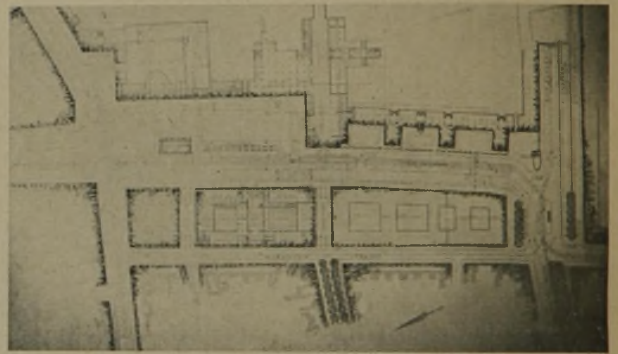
Lageplan zum Entwurf „D-Zug“. (1 : 7000.)
